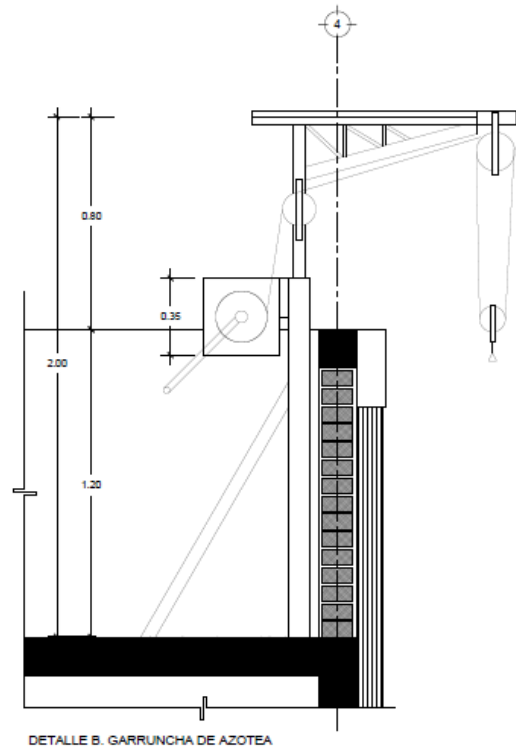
Detalle de la garruncha, empleado en fachada.
